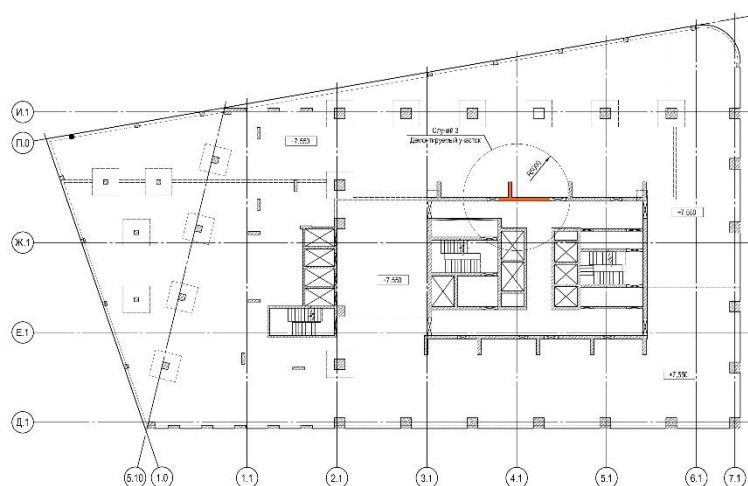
Корпус К-1. Схема аварийного случая 3
